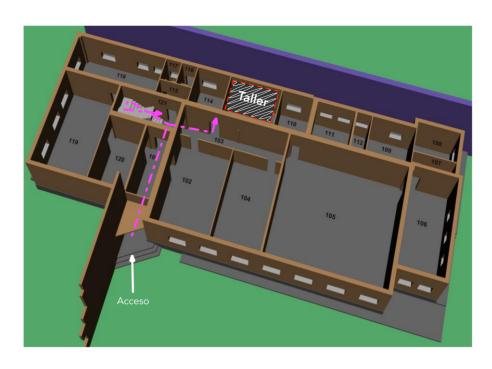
Planta baja del CAR: acceso desde el exterior al taller y a la planta primera
